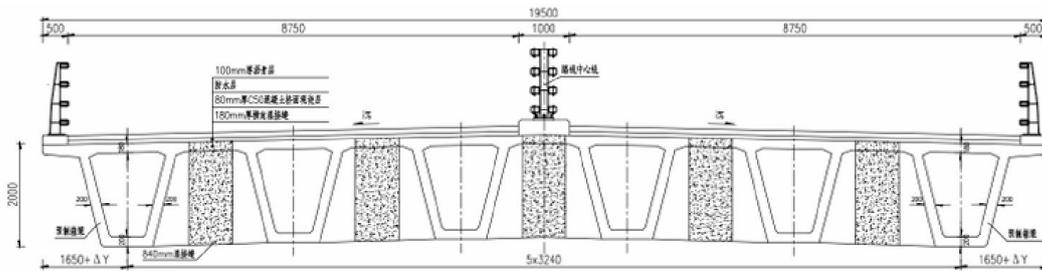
牙城湾特大桥路基标准横断面图 (单位: mm)
